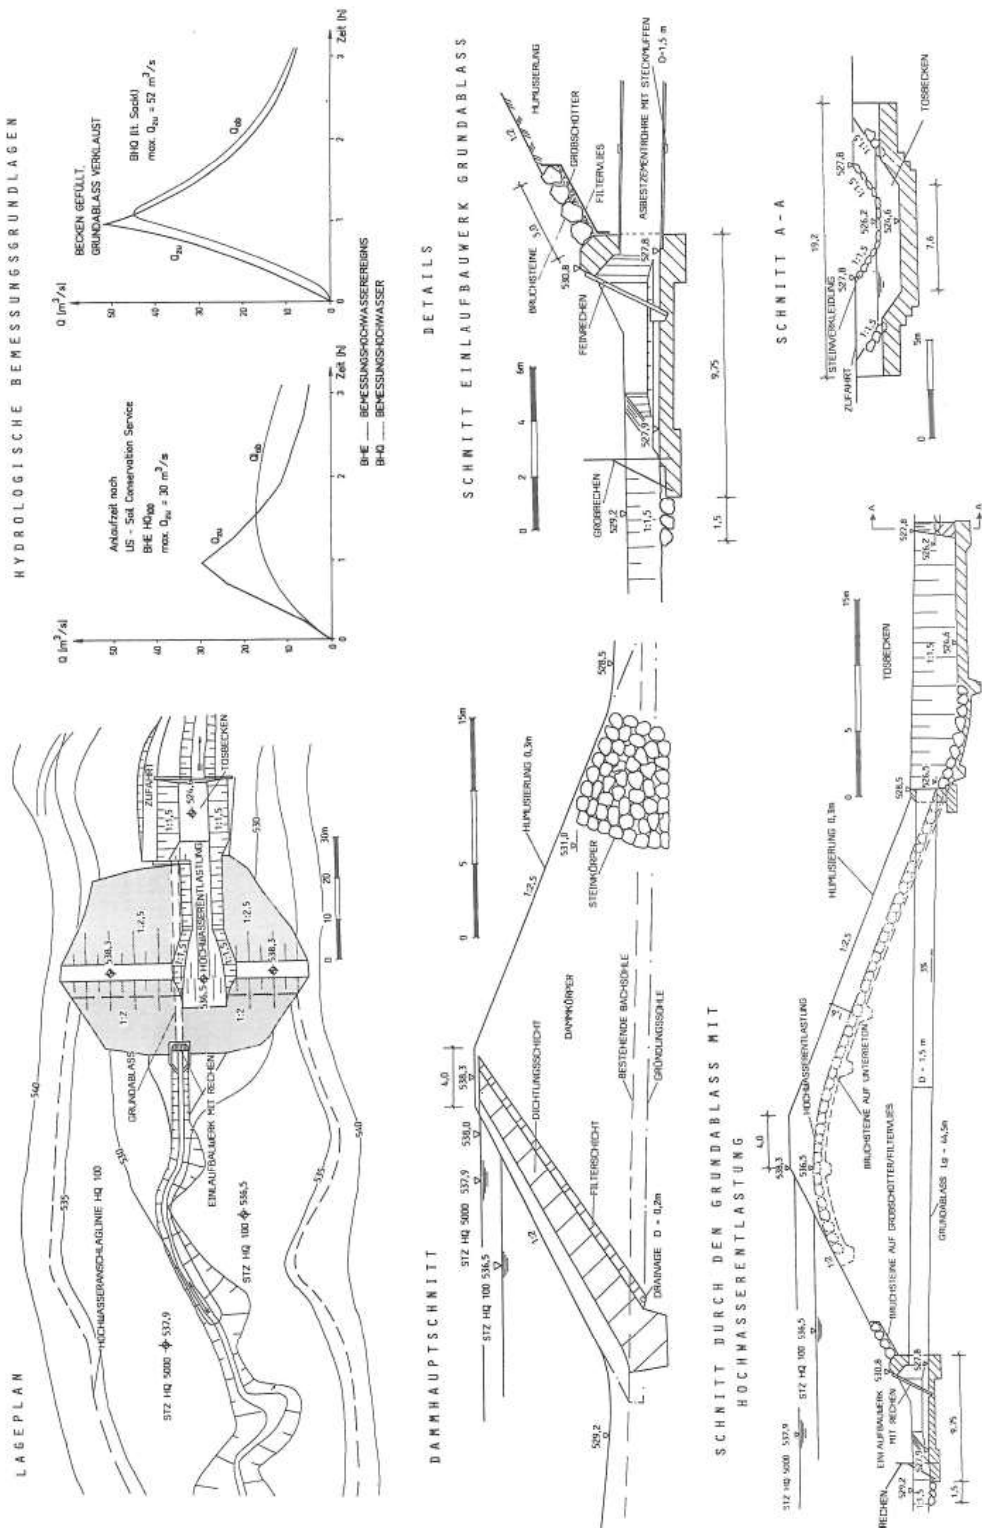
Lageplan und Schnitte, HRB Deuchendorferbach
